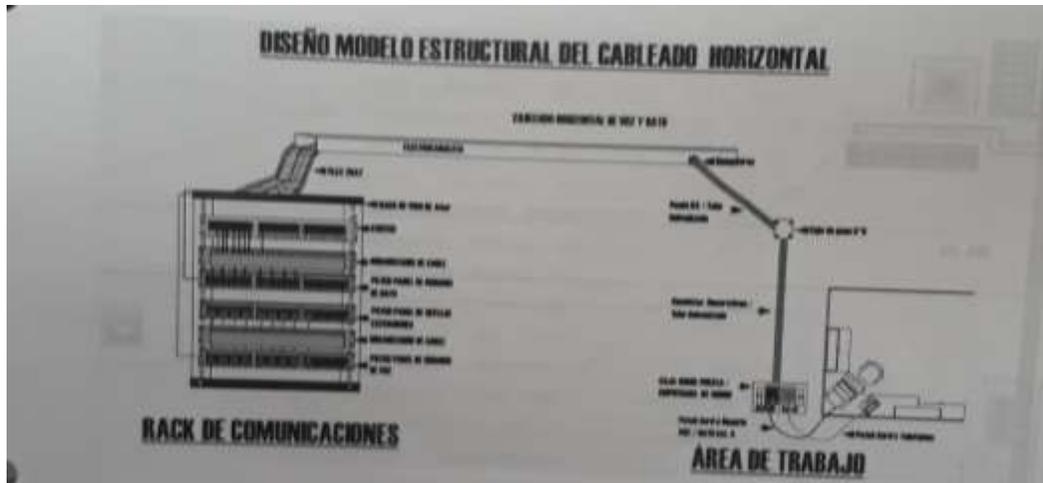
Modelo Estructural del Cableado Horizontal del GADCU
